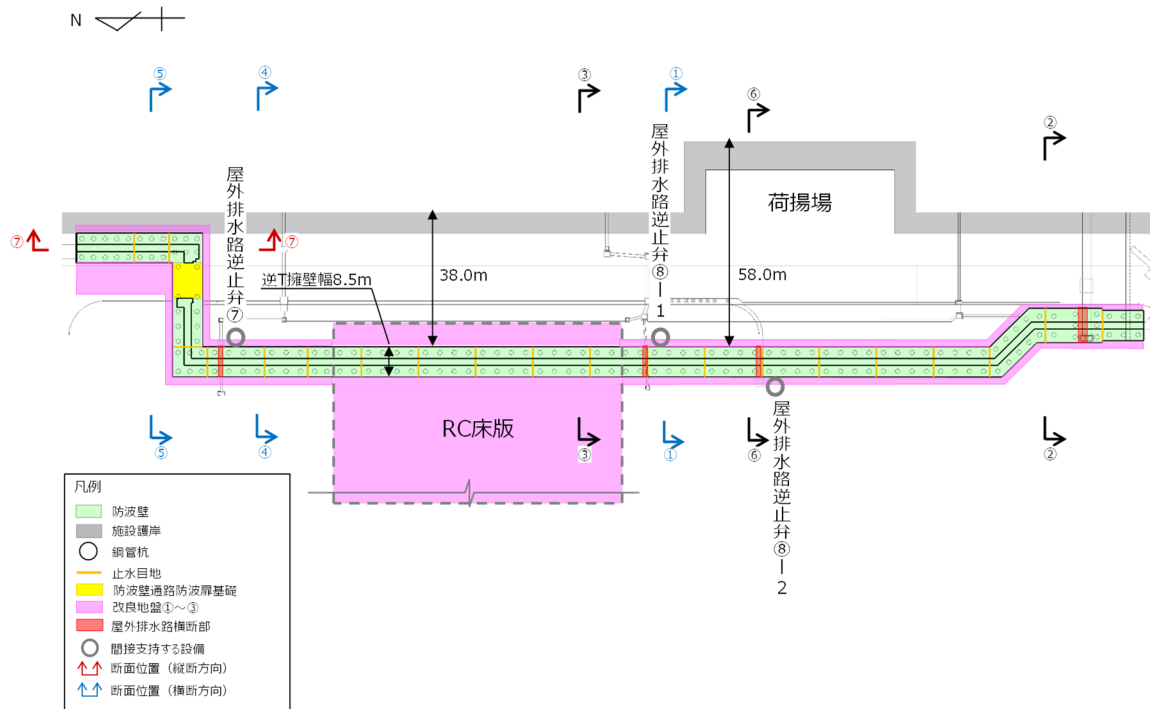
評価対象断面（縦断方向）の平面位置図
